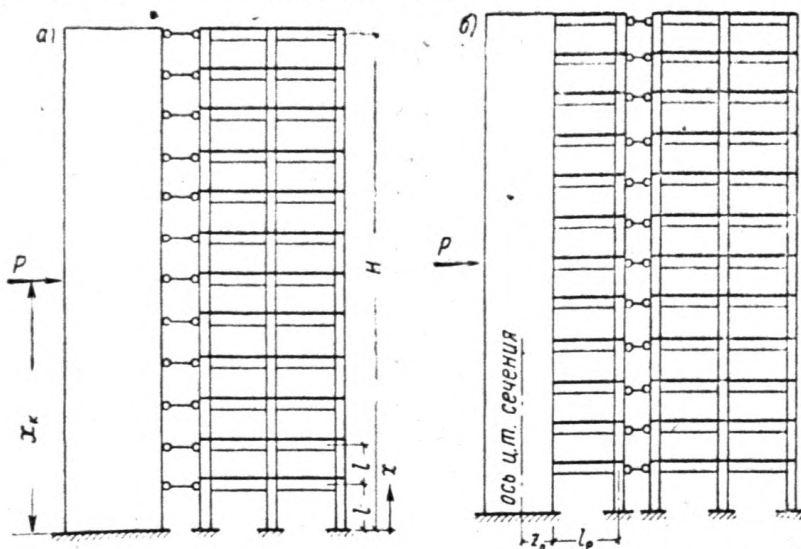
Расчетная схема рамно-связевого каркасного здания высотой 9 этажей и более
